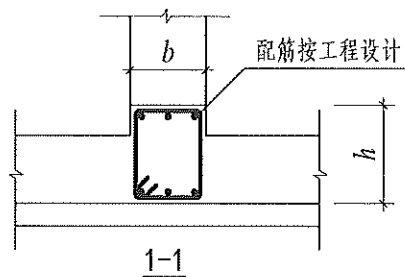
筏形基础底板墙体洞口下过梁配筋构造
